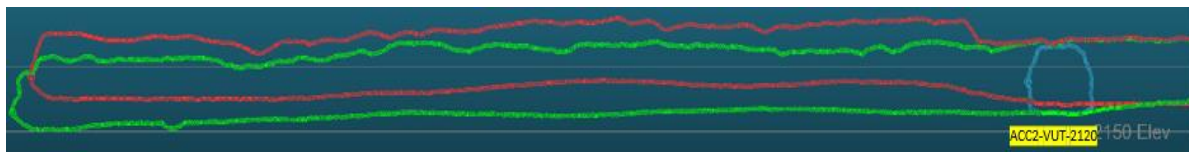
Vista longitudinal de corte en rebaje 2120 central. (geología, 2024)
